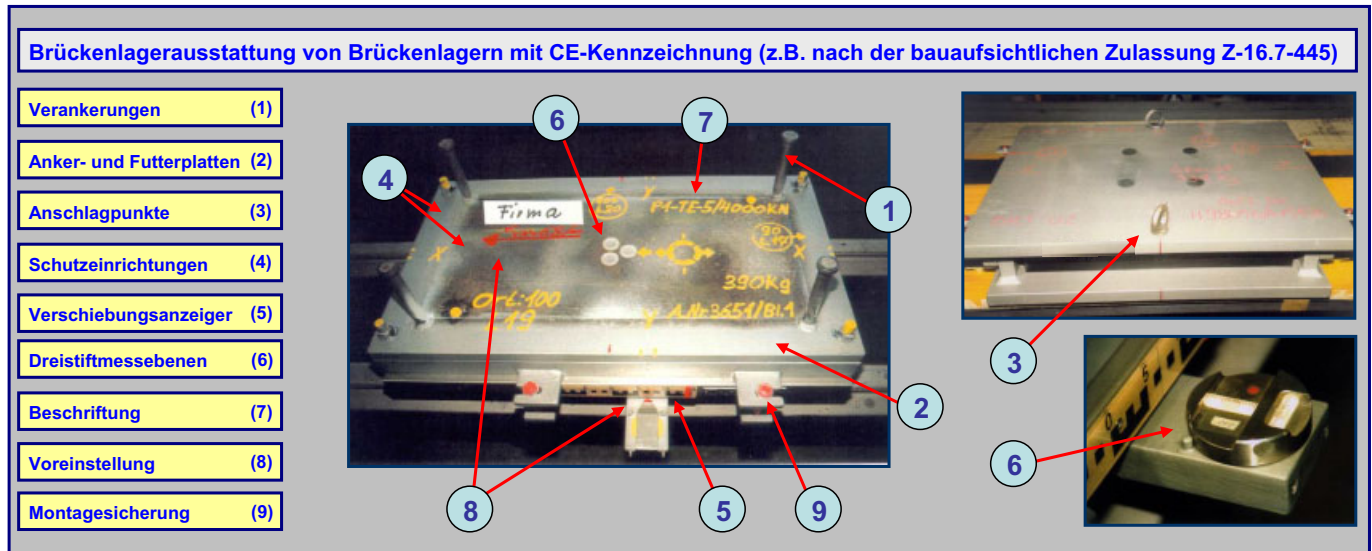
Wesentlicher Inhalt der bauaufsichtlichen Ausstattungszulassungen (z. B. [10]) für Brückenlager mit CE-Kennzeichnung
